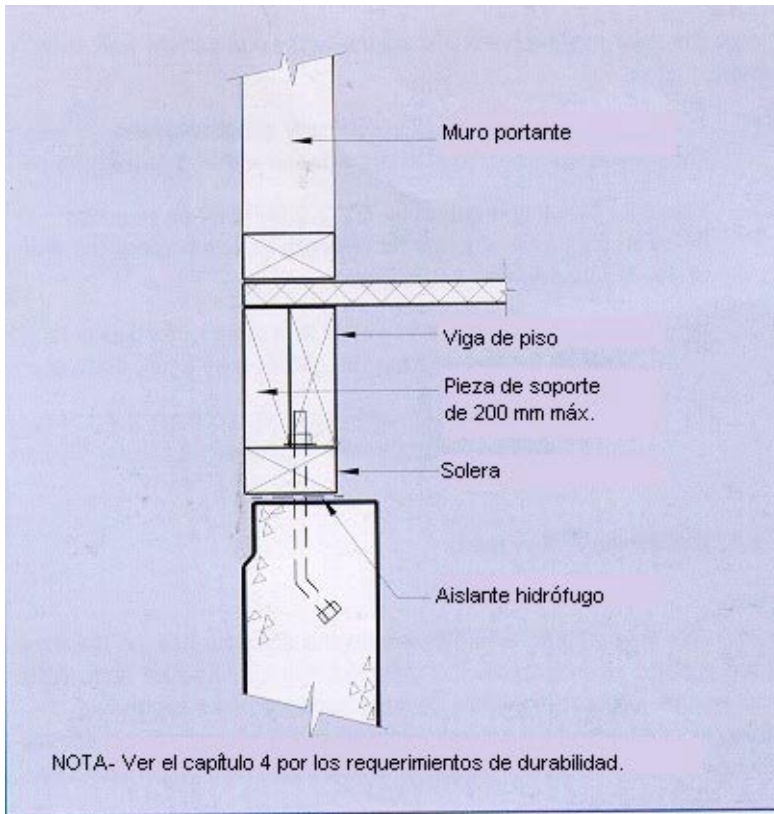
Muro portante sobre fundación (ver 7.1.3.4)
